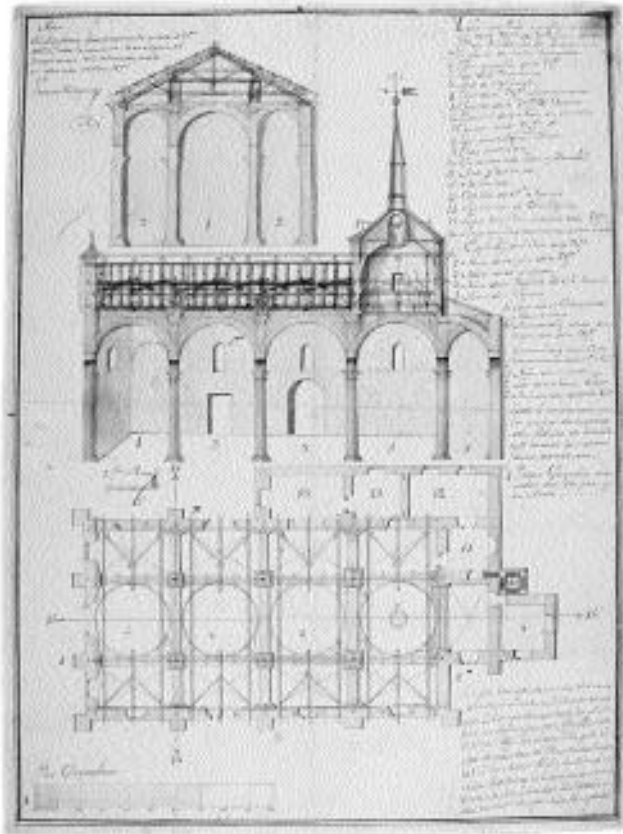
Planta y alzado de la Iglesia de San Miguel de Ventura Rodríguez. Año 1770 (AHN, Frías 1633-3, sf.).
